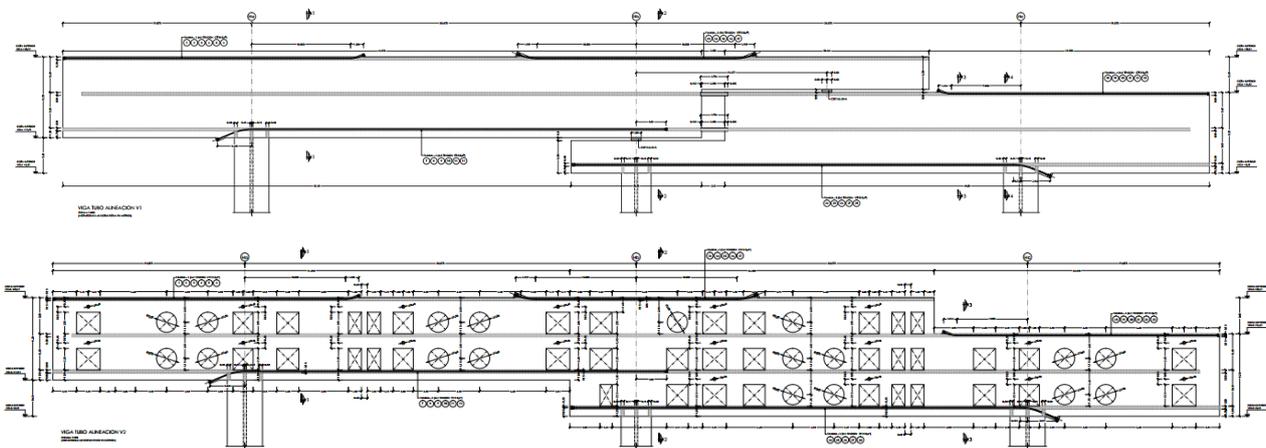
Alzado viga tubo. Arriba cara exterior. Abajo pared cara interior con pasos
